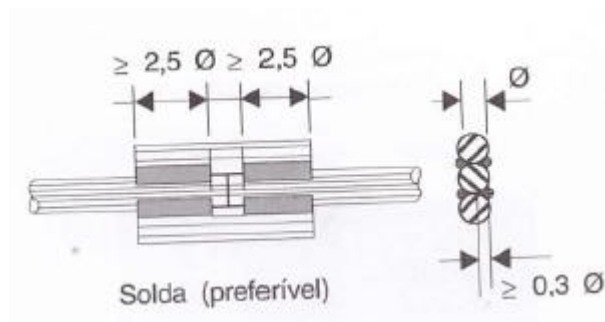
Emenda por soldadura, extraído de [19].
